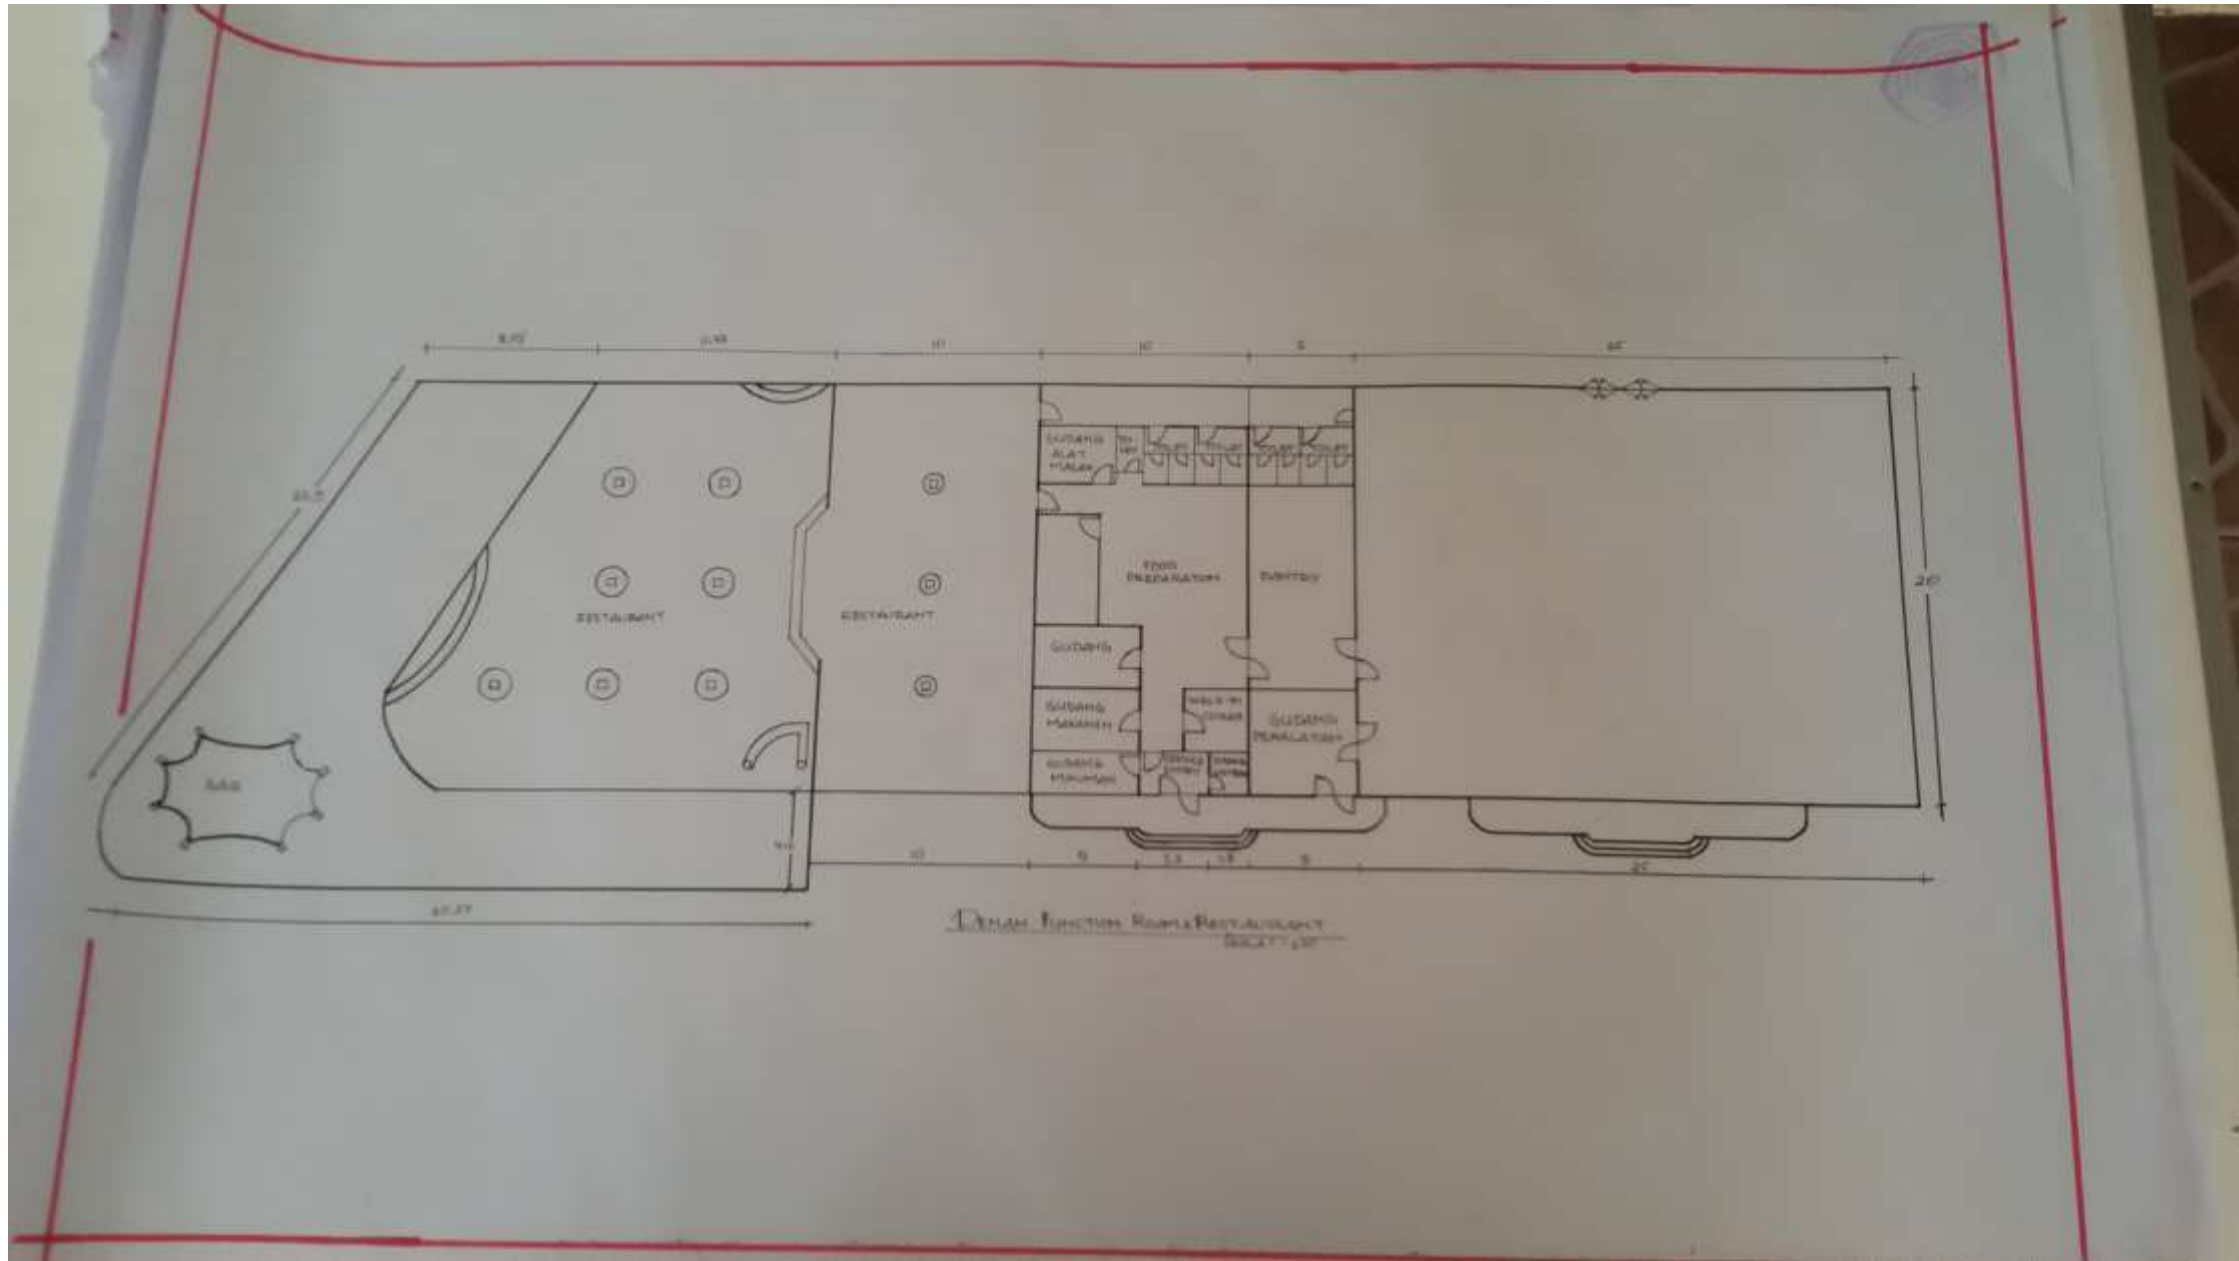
Siteplan (Sumber: DokumenPribadi)
